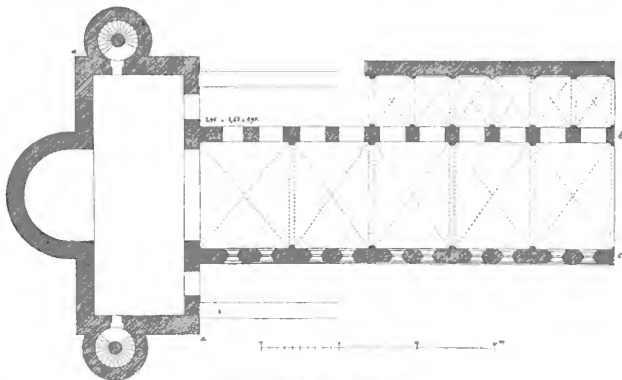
Grundriss des Domes zu Mainz.
